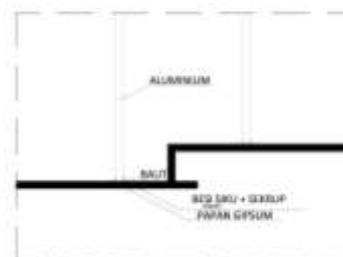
Potongan Ruang Kelas 3-5 tahun (4)
